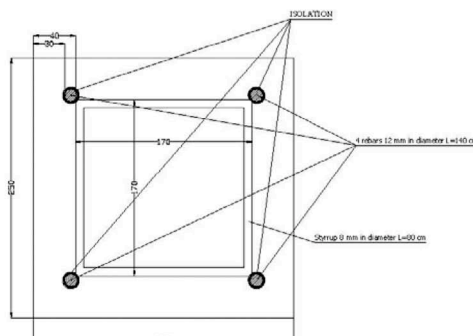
Disposizione dell'armatura nei travetti nel calcestruzzo armato.
